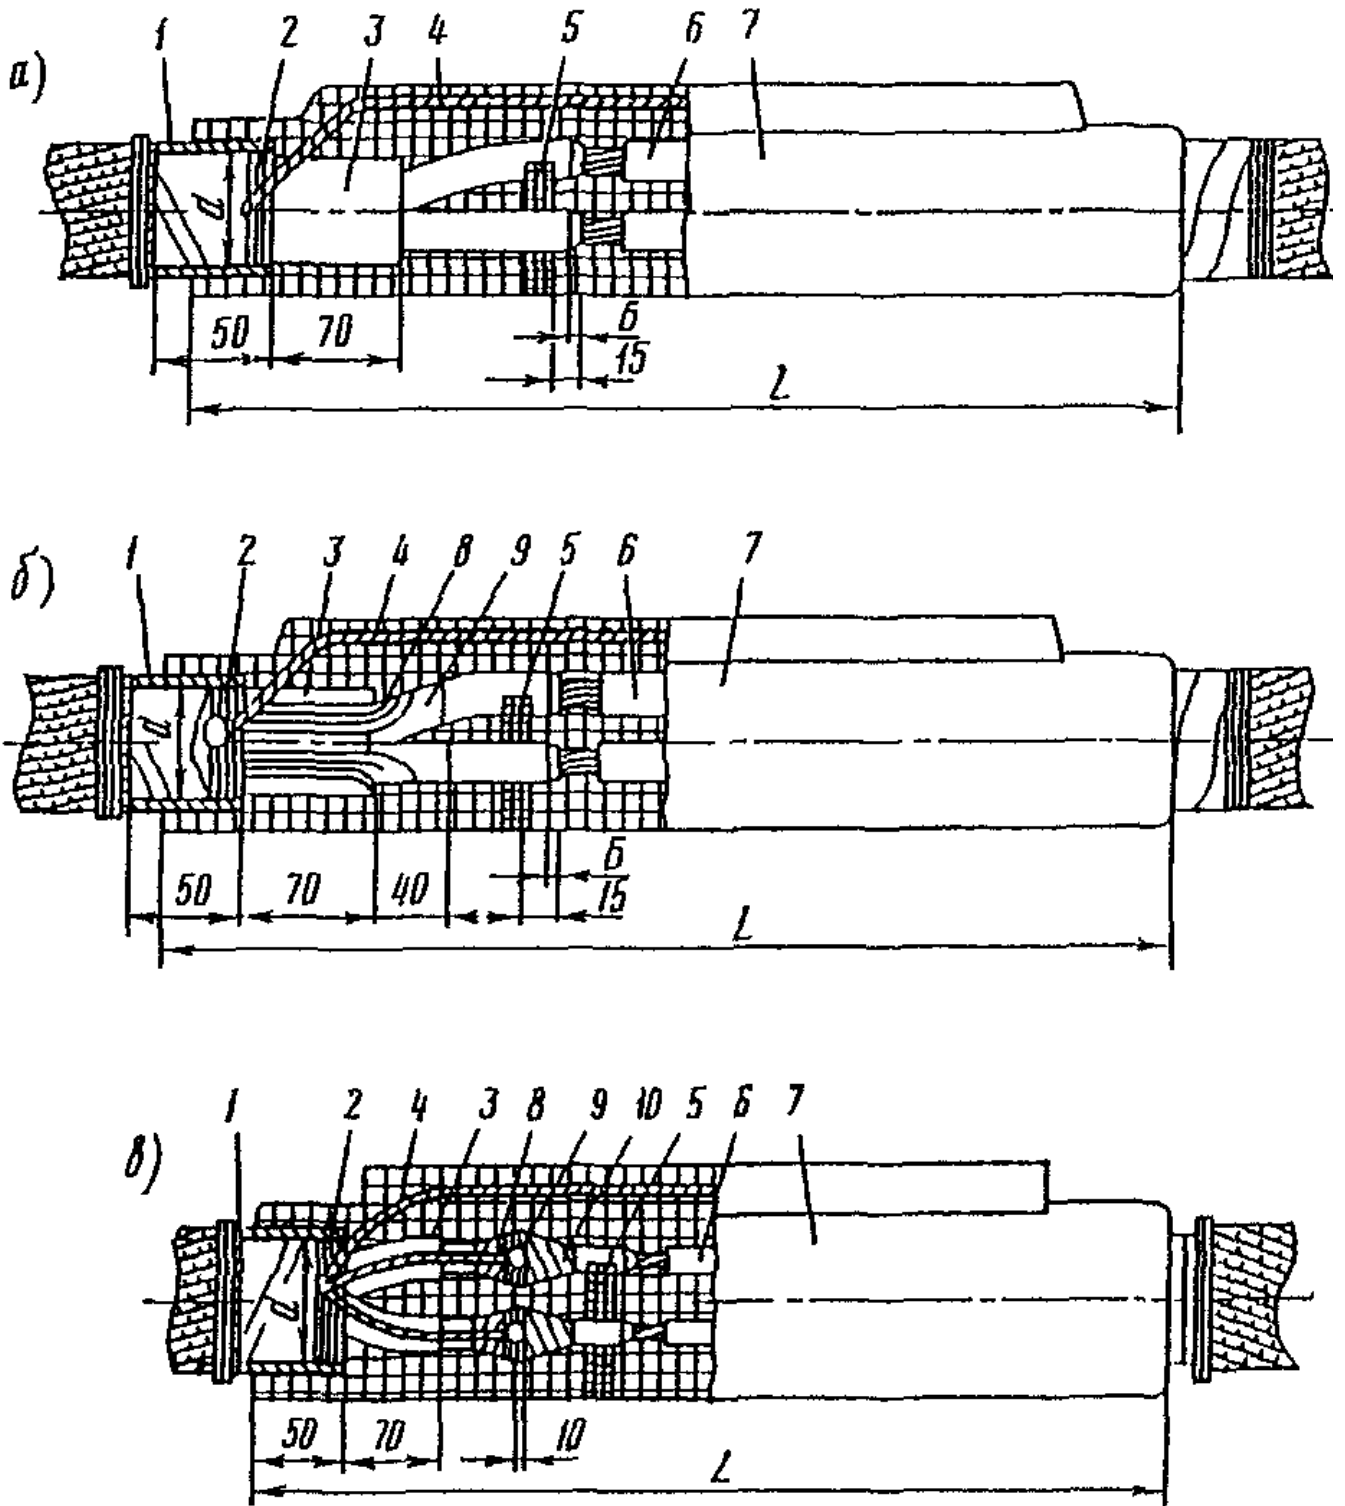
Соединительная муфта для кабелей с пластмассовой изоляцией: а, б, в - напряжением соответственно 1, 6 и 10 кВ; 1 - подмотка из хлопчатобумажной ленты; 2 - бандаж; 3 - шланг; 4 - провод заземления; 5 - распорка; 6 - соединительная гильза; 7 - корпус муфты; 8 - лента металлического экрана; 9 - полупроводящий экран; 10 - конусная подмотка
